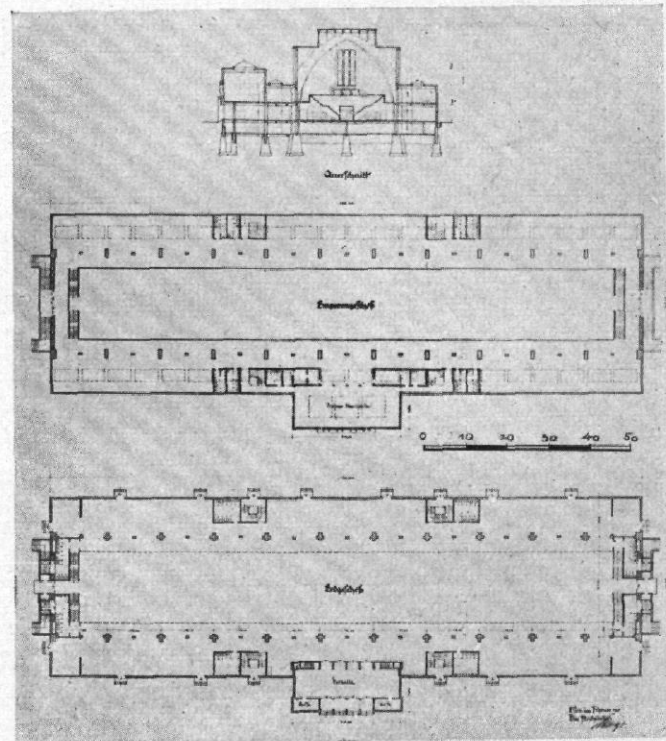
bis 10 / Ausstellungsballe in Essen / Querschnitt und Grundrisse
